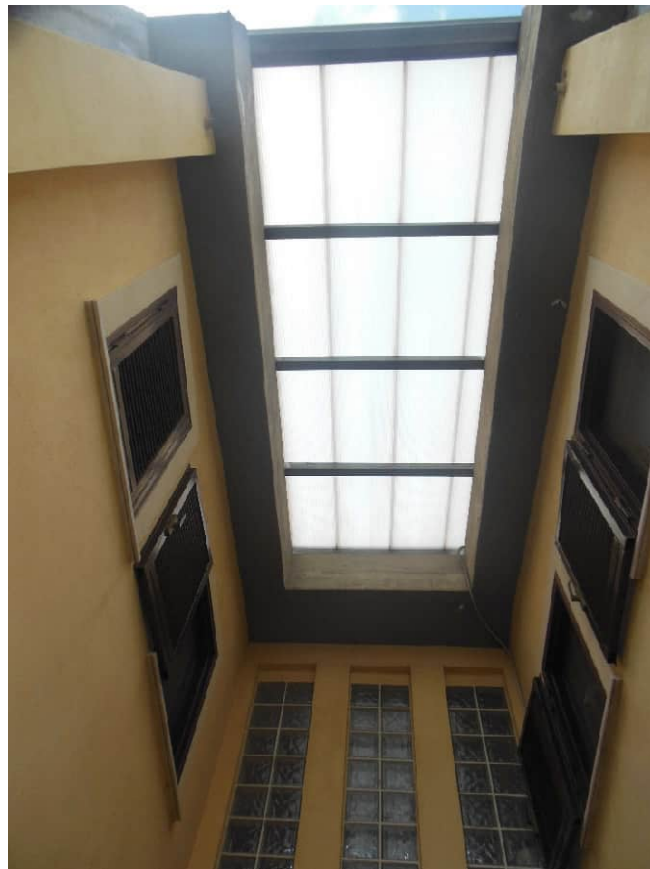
piano primo Unità n. 2: dettaglio copertura terrazzino
